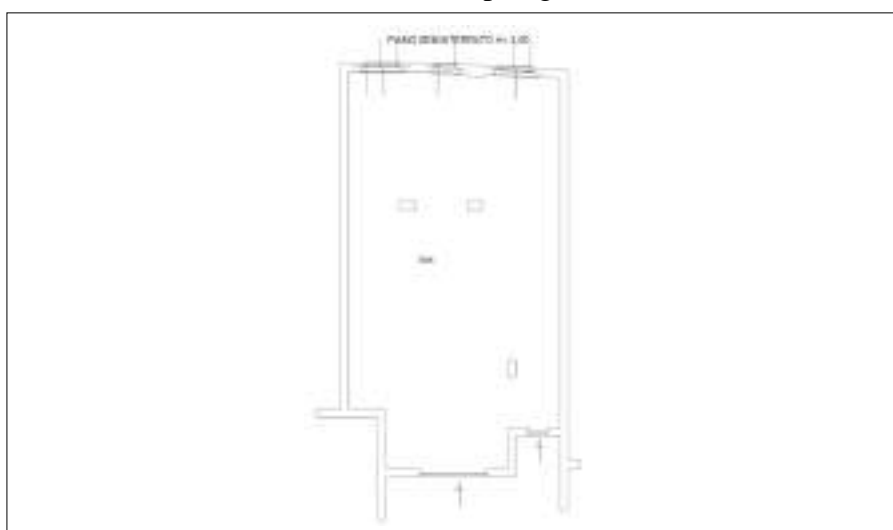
Planimetria dell'appartamento posto al piano terra sub 28
